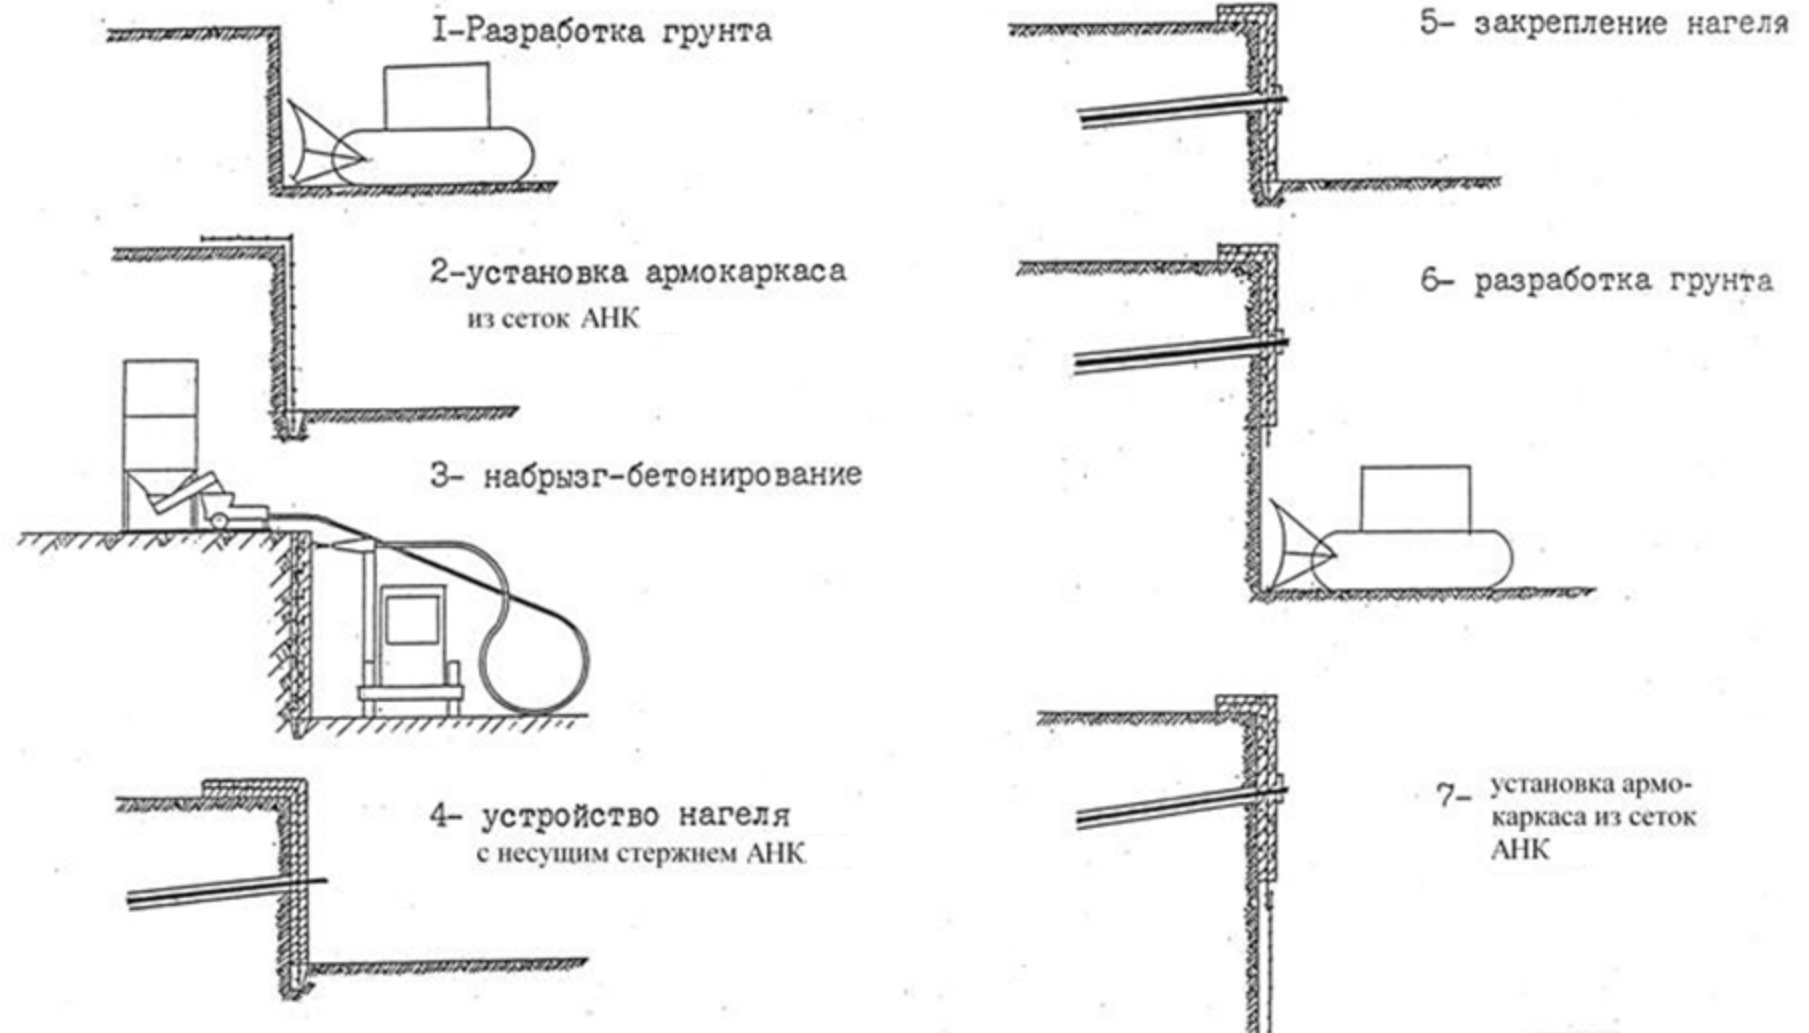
Технология устройства нагельного крепления с набрызг-бетонным экраном и буроинъекционным нагелем с несущим стержнем АНК
